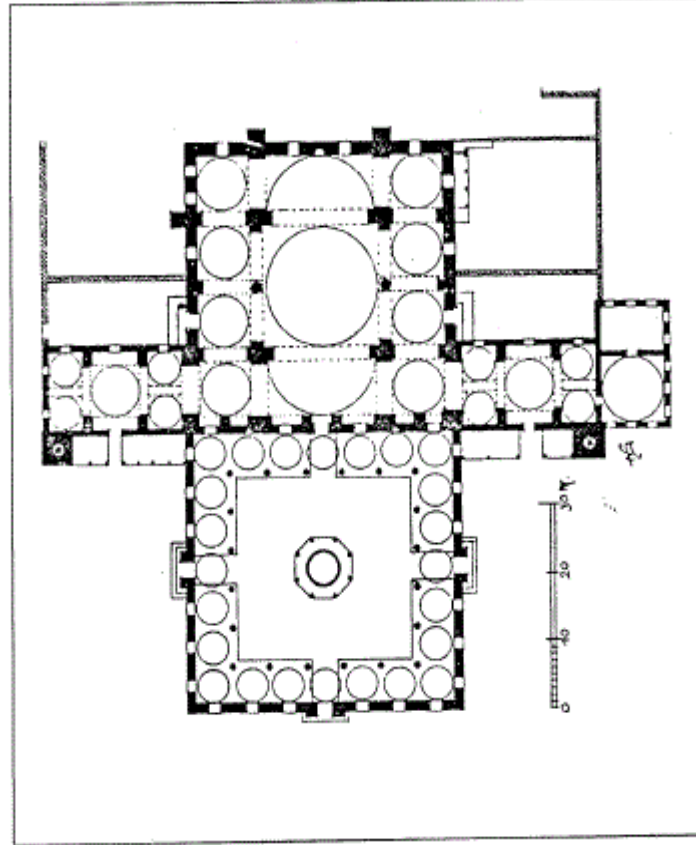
مسقط أفقي لمسجد ومدرسة سنان باشا في بشكطاش بإستانبول (عن :
